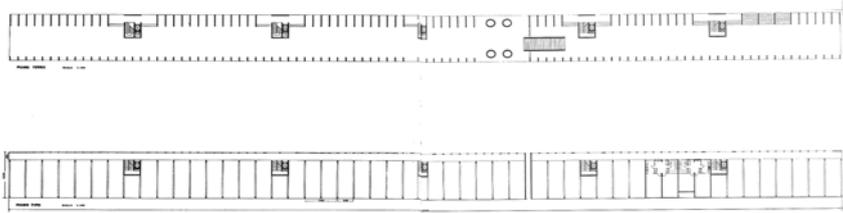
Grundriss Erdgeschosszone (o), Regelgeschoss (u)
